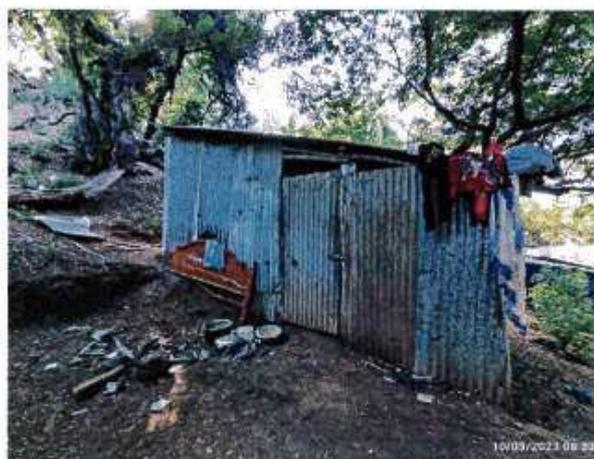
construction dépourvue de fondations, tôle clouée sur structure en bois, manque d'éclairage naturel dans la pièce de vie
